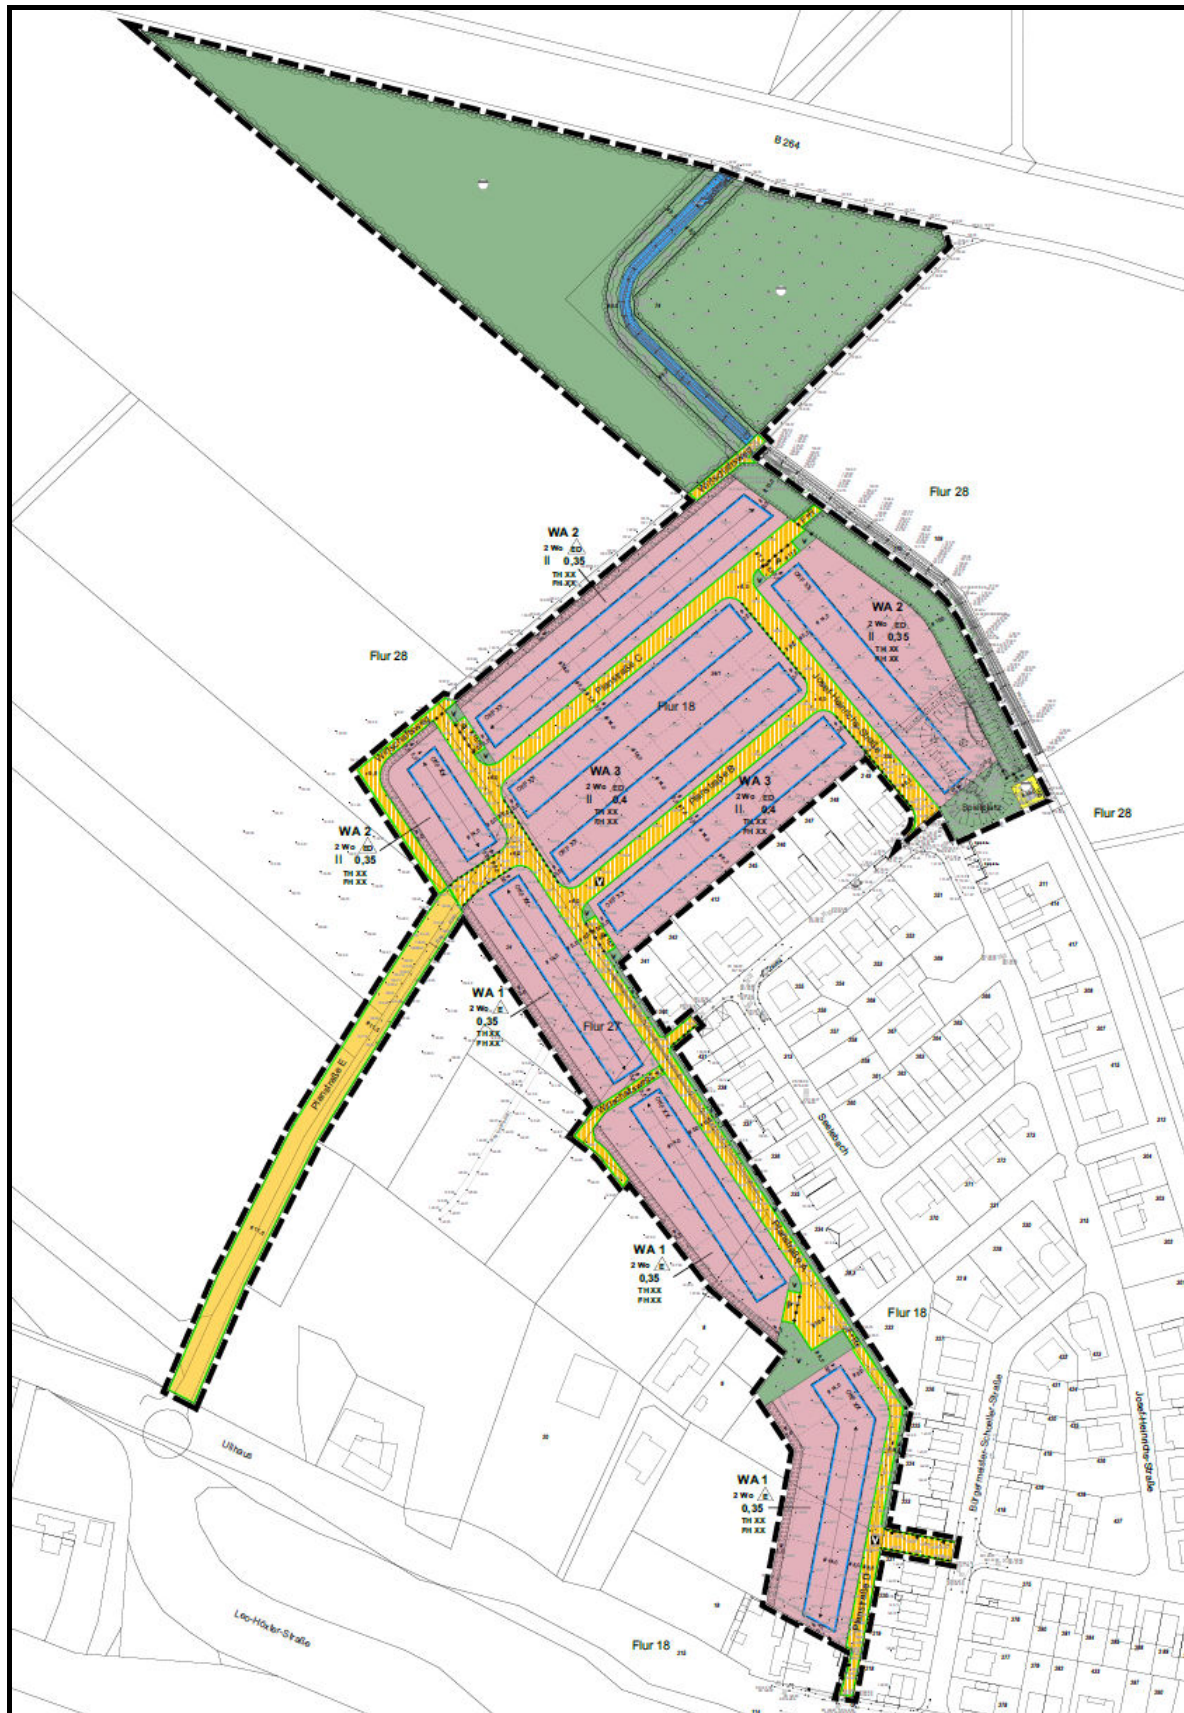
Entwurf des Bebauungsplans F 24 - Stand: 13.08.2021
